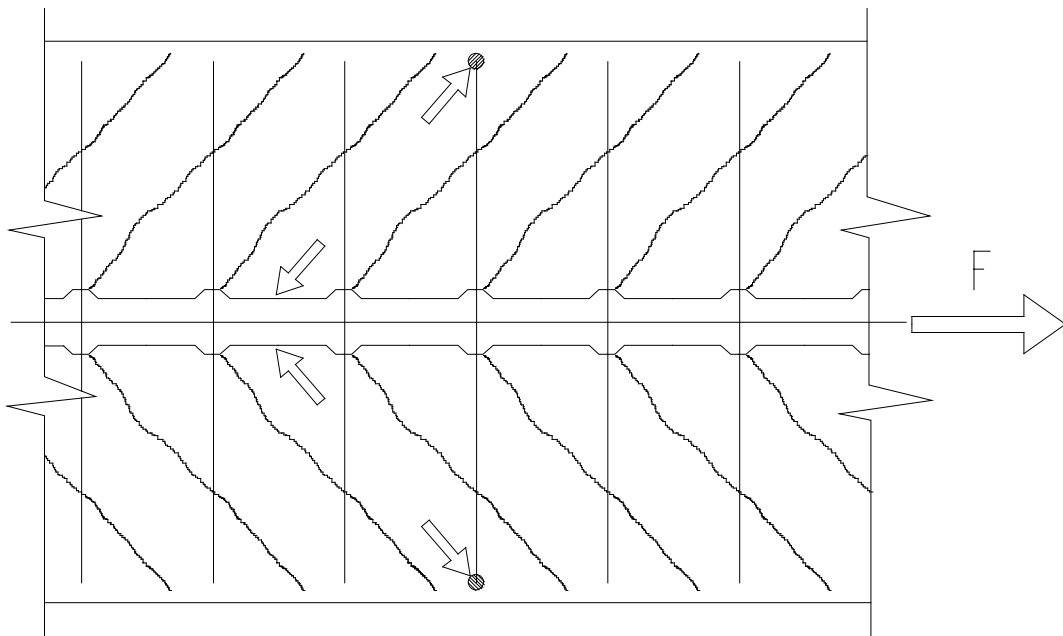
Particolare del traliccio resistente attivato dall'armatura trasversale di contenimento.
